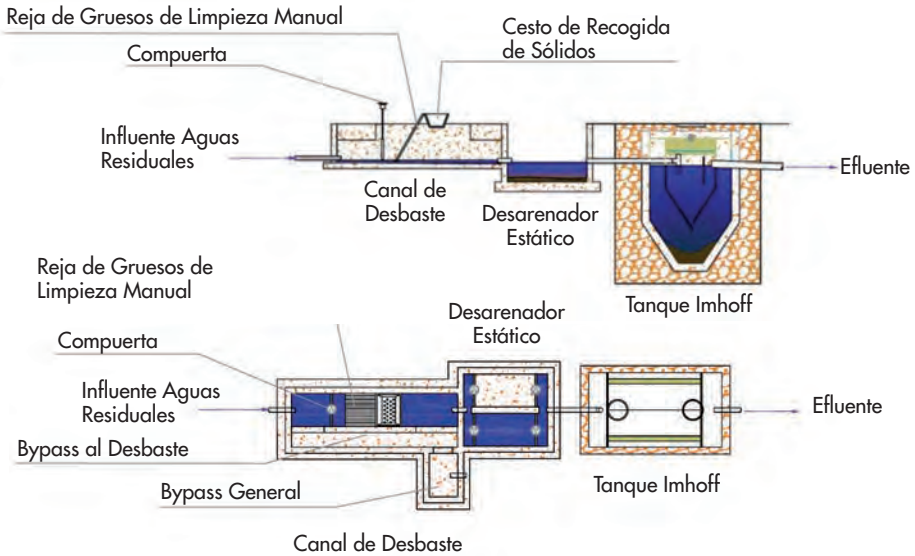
Diagramas de flujo en instalaciones de Tanques Imhoff. Perfil y planta (200-500 h-e)
